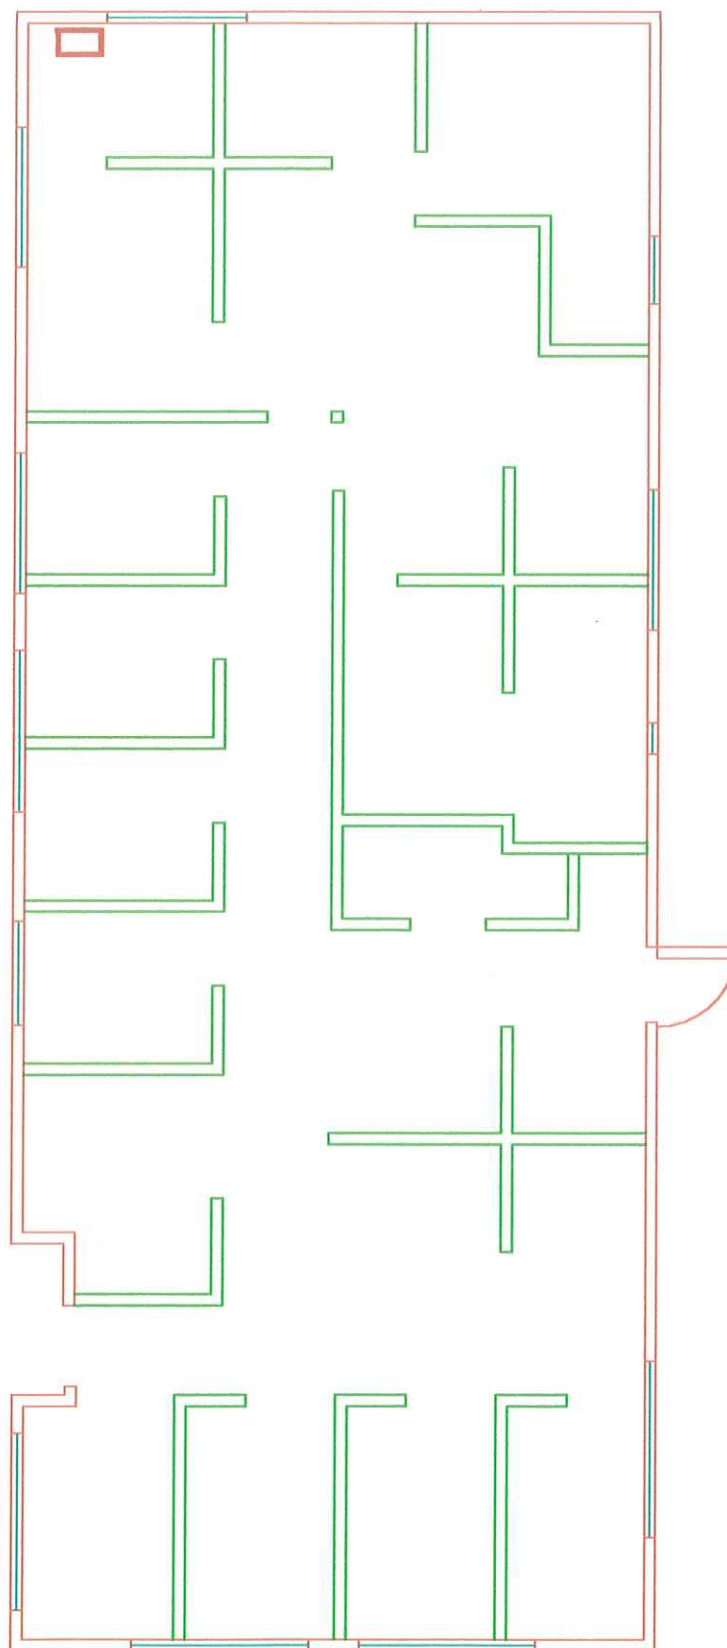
Tubería Propuesta Para El Cableado En La Sala De Los Maestros
